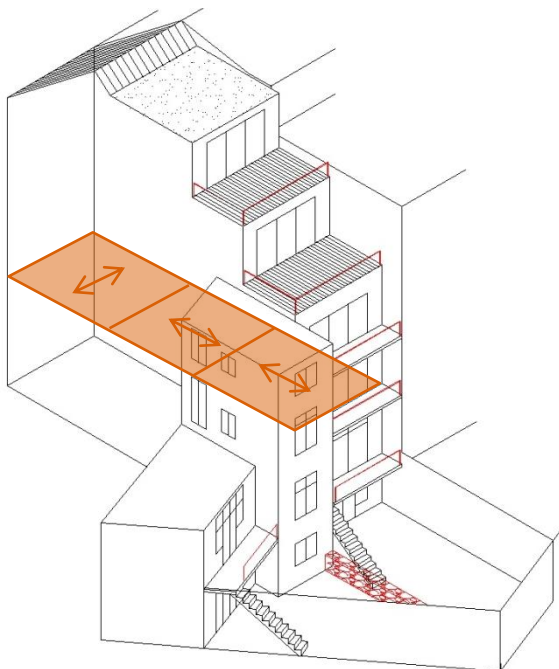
Sens de portée du plancher (Source : Draps E., 2010)
